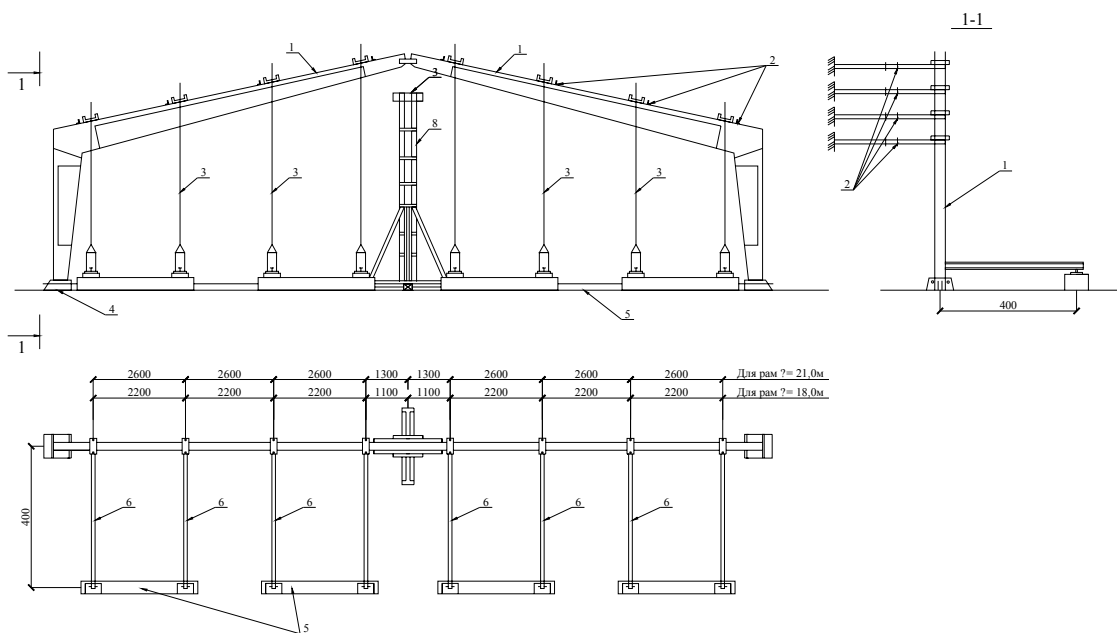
Схема стенду для дослідження рамних каркасів:
